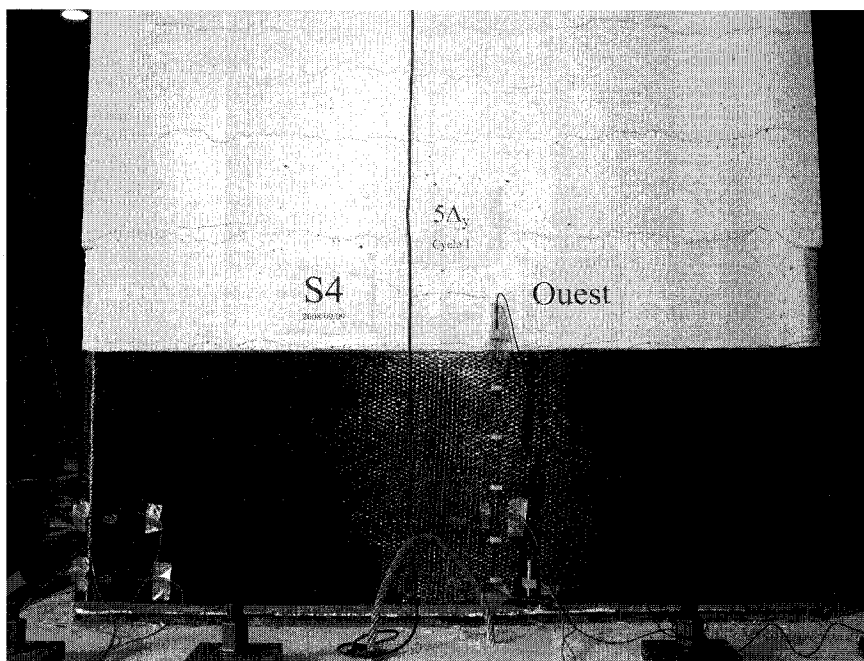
Photo de la face ouest de S4 à la fin de l'essai
